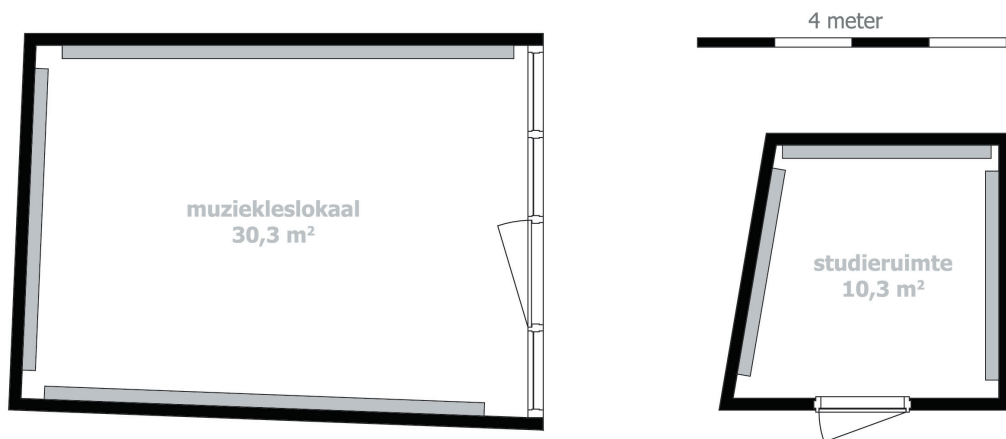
Testruimte van studieruimte in de fietsenstalling. (Knigge, 2005)
